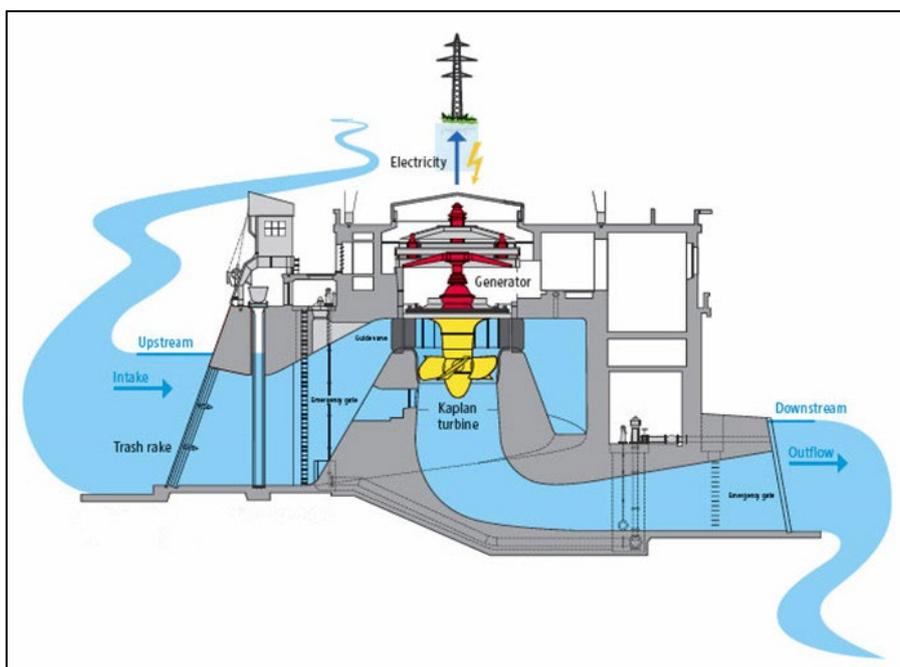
SCHEMA CONCETTUALE ESEMPLIFICATIVO IMPIANTO IDROELETTRICO CON KAPLAN VERTICALE
